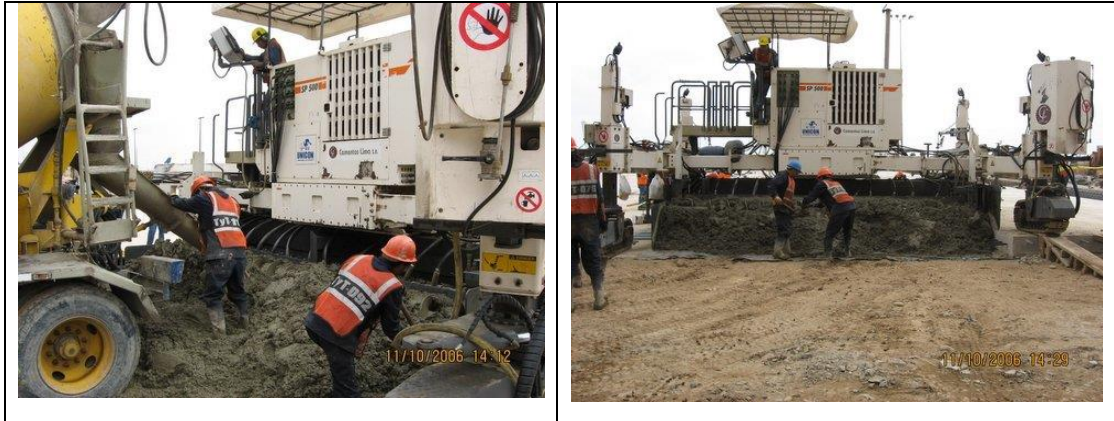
Pavimentadora de concreto en operaciones de pavimento rígido (Asocem).
